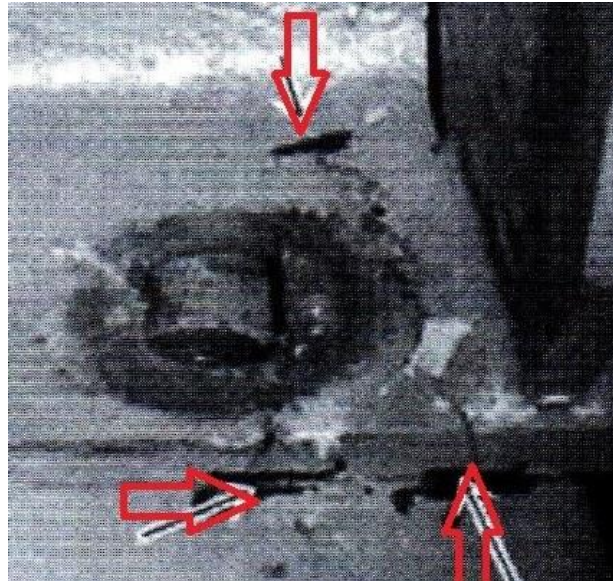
Fisuras entre los agujeros de los taladros de la viga del transformador nº 2.
